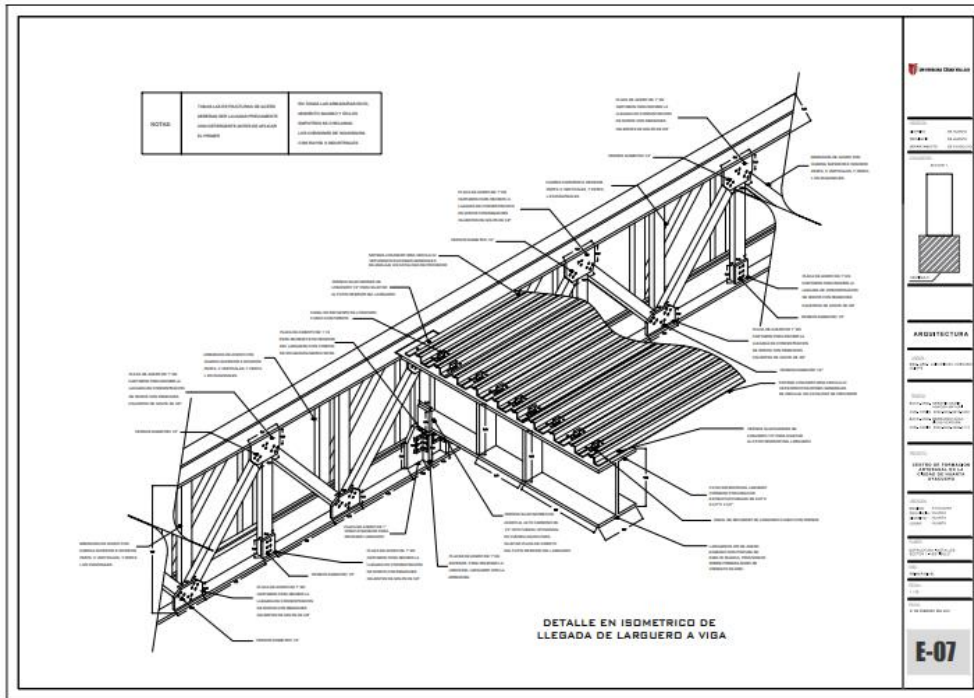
Plano de detalles de la cubierta - escala 1/5.
